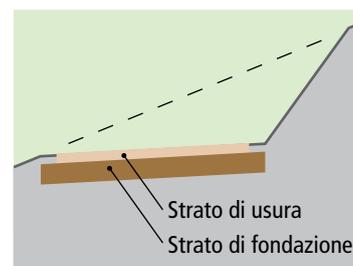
Profilo normale di un sentiero con strato di fondazione
